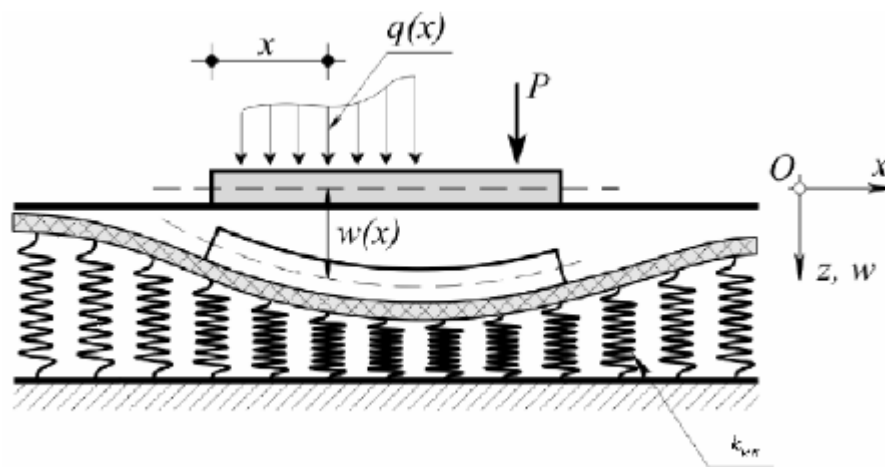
Une poutre repose sur une fondation élastique (Winkler-Paster)
